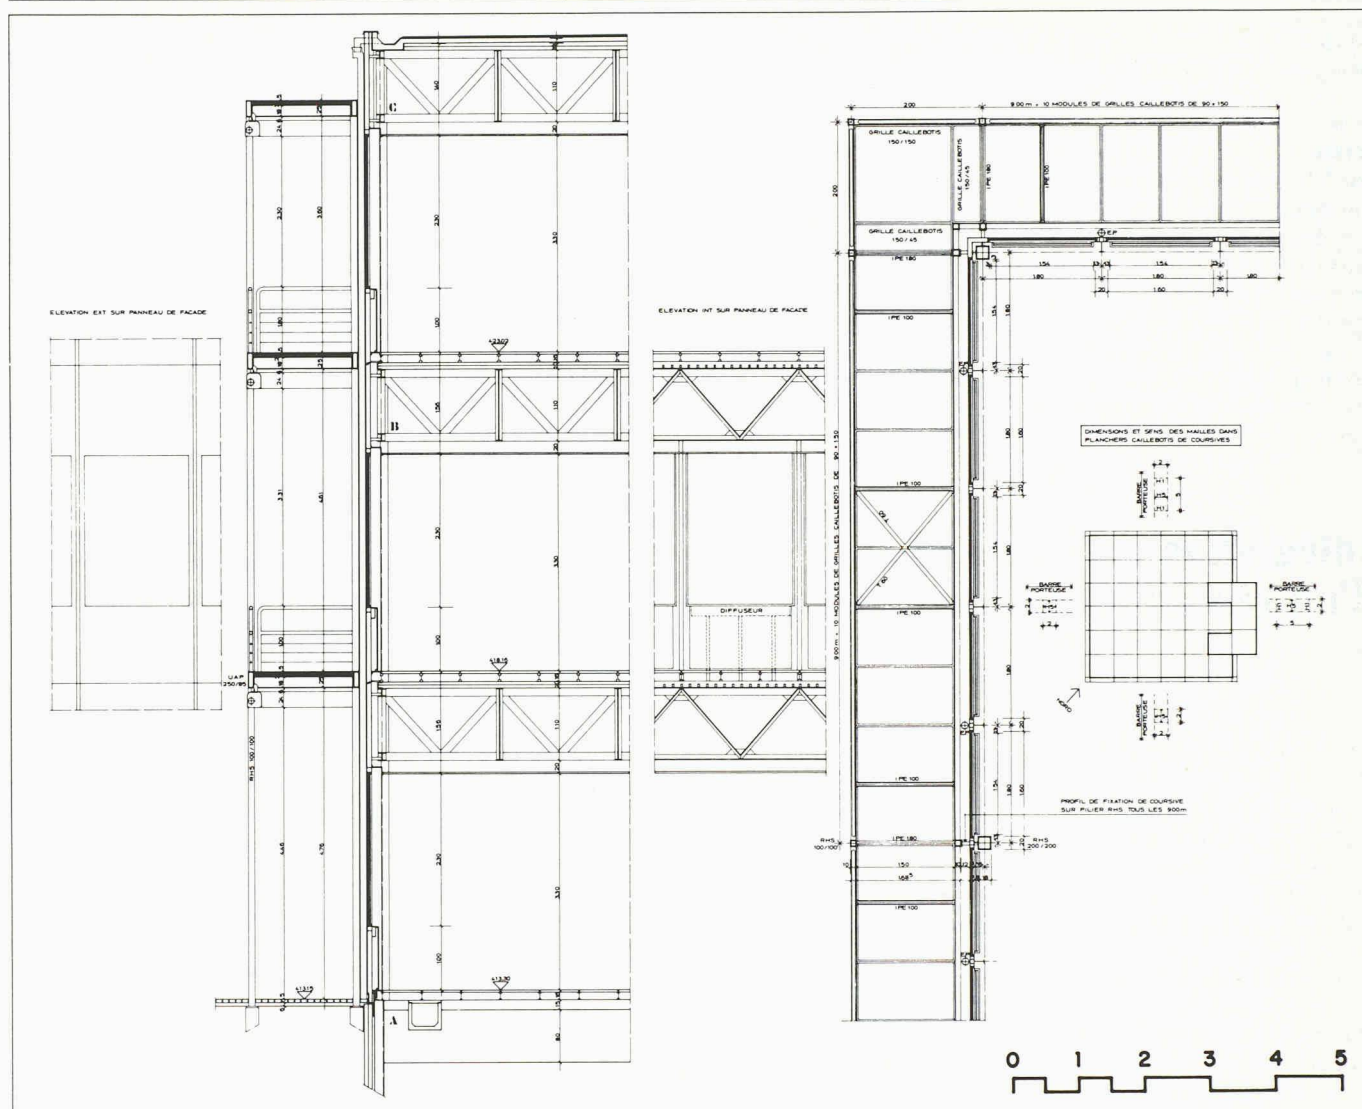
Détails de construction de la façade, montrant notamment les dispositions prises en fonction de l'équipement du bâtiment.
